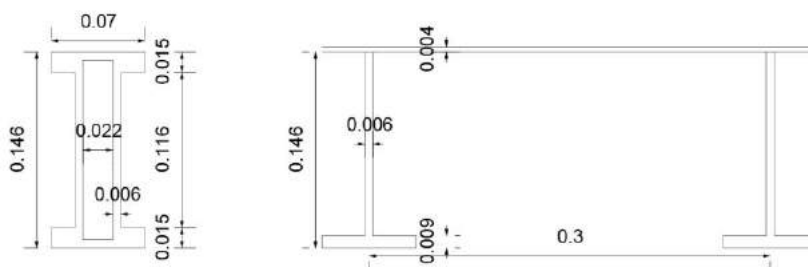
Piezas estructurales de Forjado de cubierta [39]
